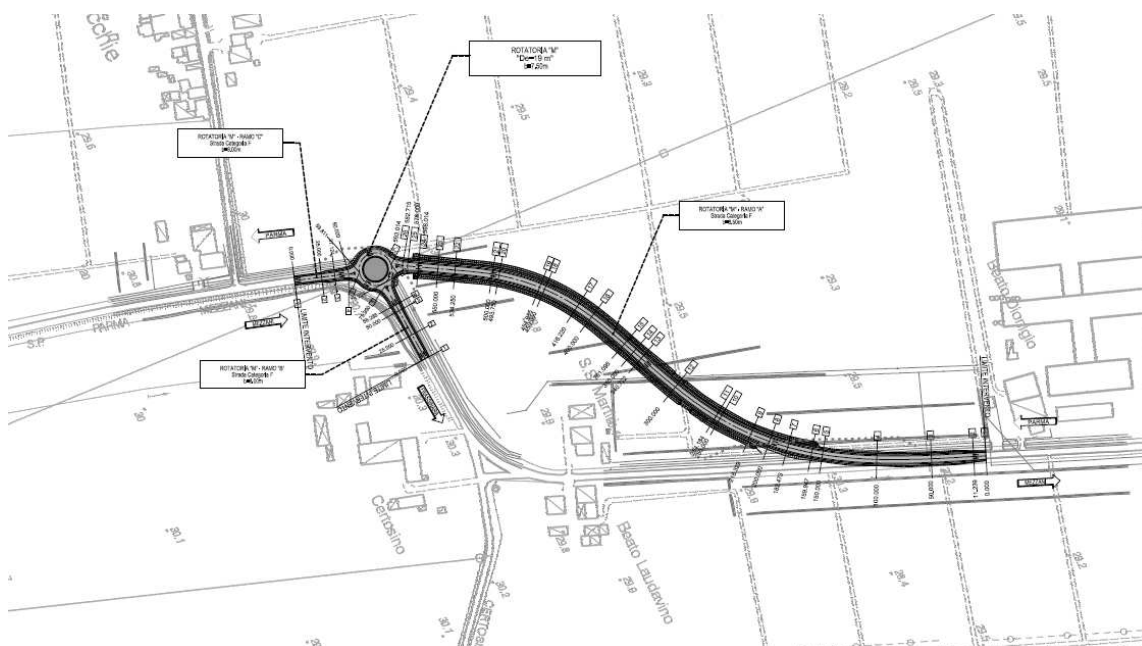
PLANIMETRIA DI PROGETTO – TRATTO 1 - OPERA D01 (EX 1PR)
